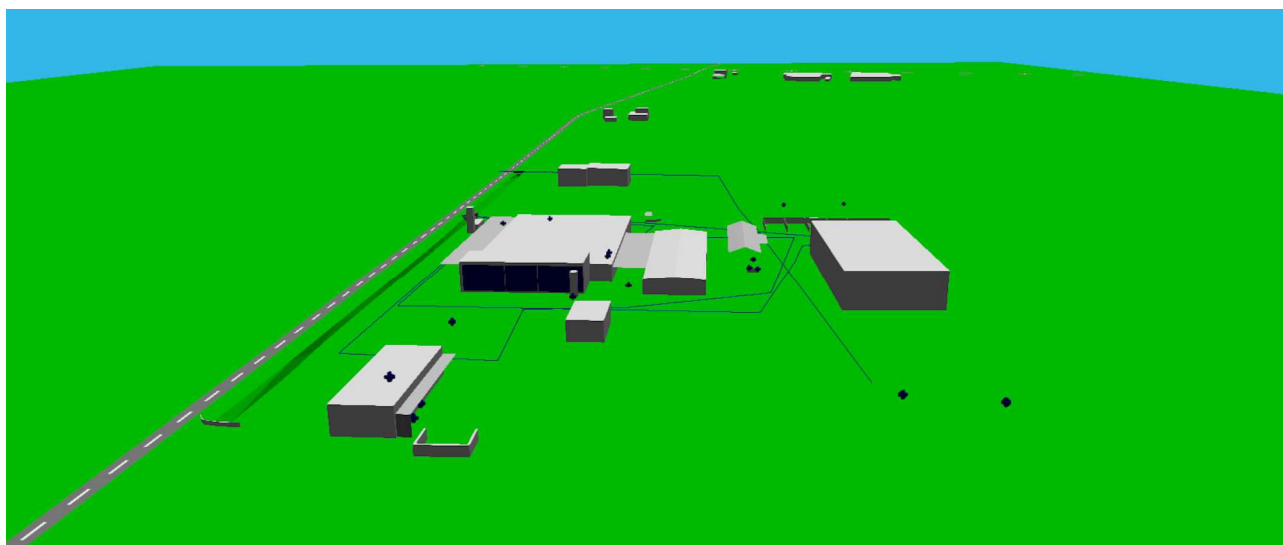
Vista Nord Ovest Cantiere NORD
